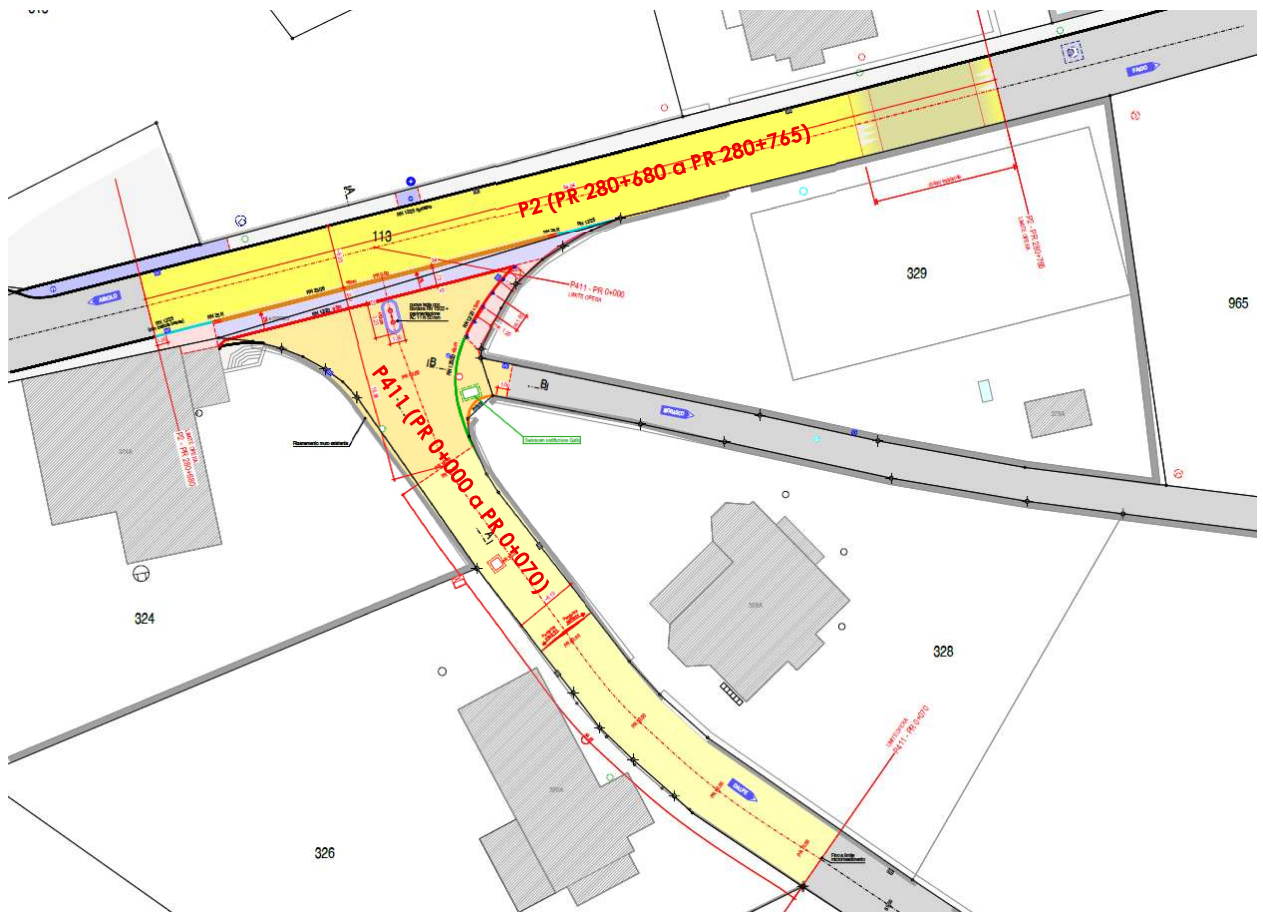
Estratto planimetria pavimentazione (da piano N°1009.701_D003)
